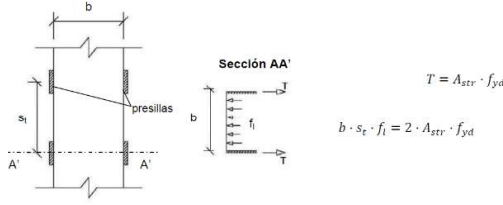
Equilibrio de fuerzas en el pilar empresillado.
